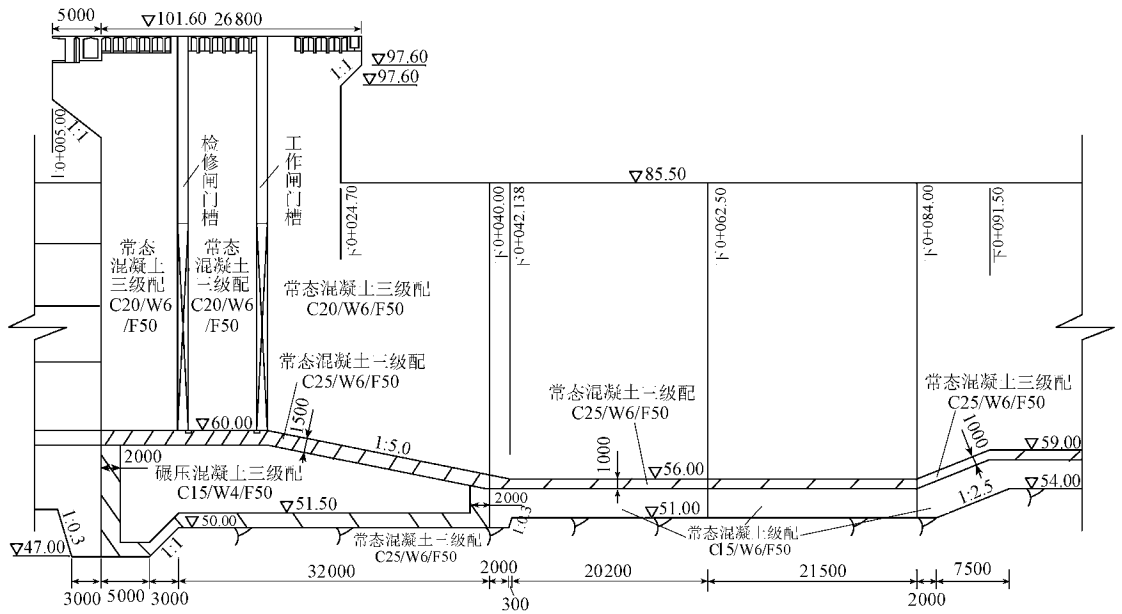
11 号泄水闸堰体立面图(高程单位：m,尺寸单位：mm)
